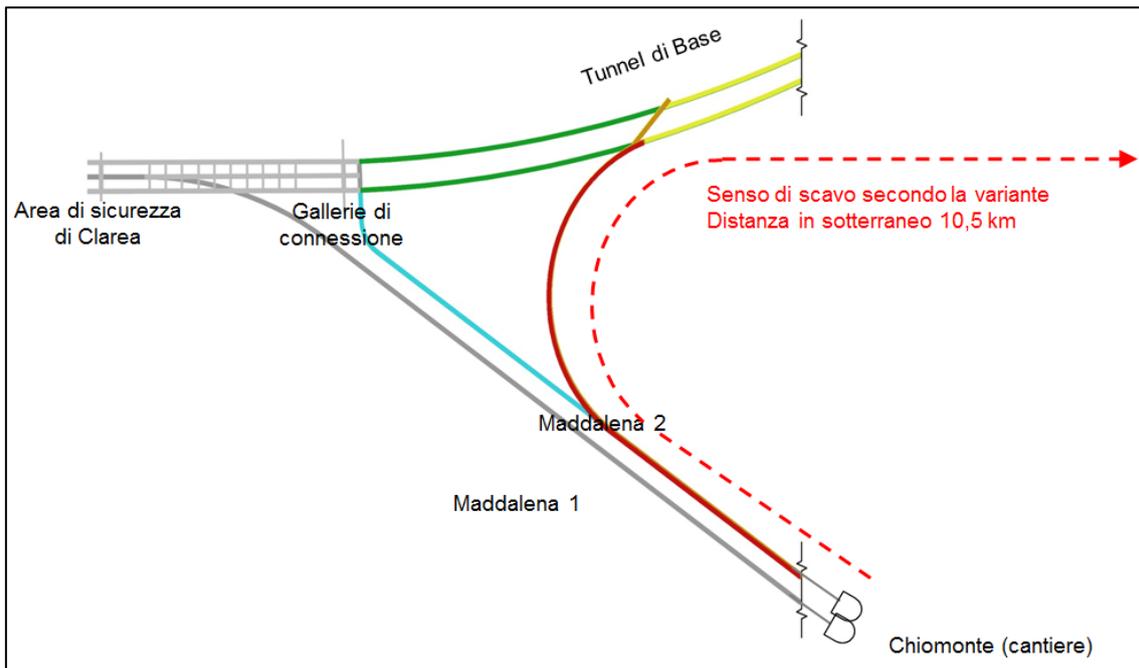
Schema gallerie Maddalena (opere realizzate da cantiere Maddalena)
